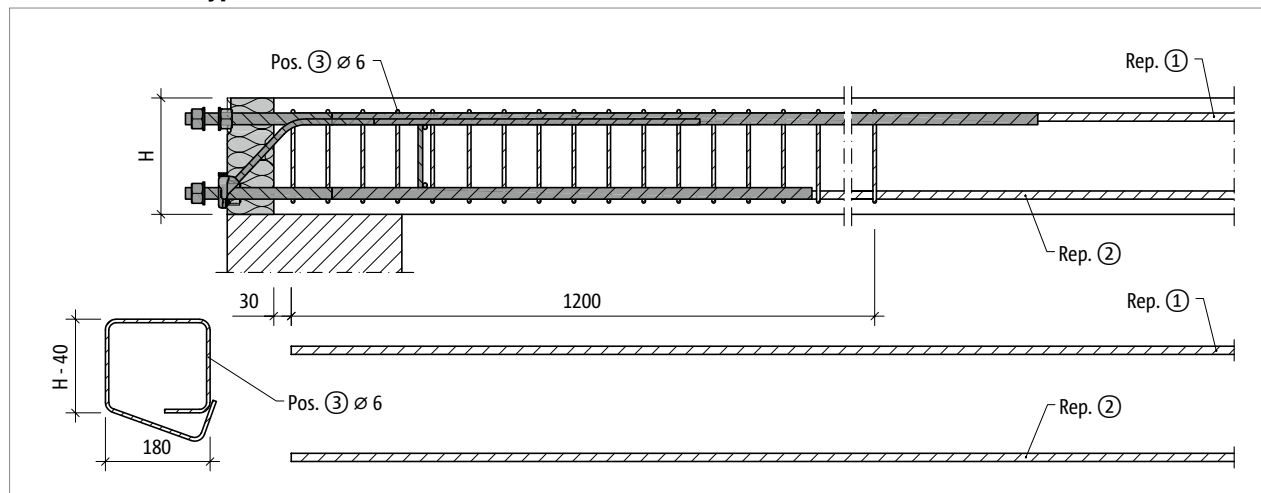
Schöck Isokorb® T type SK-MM2 : armatures à prévoir par le client avec étrier de Ø 6 mm ; vue en coupe
